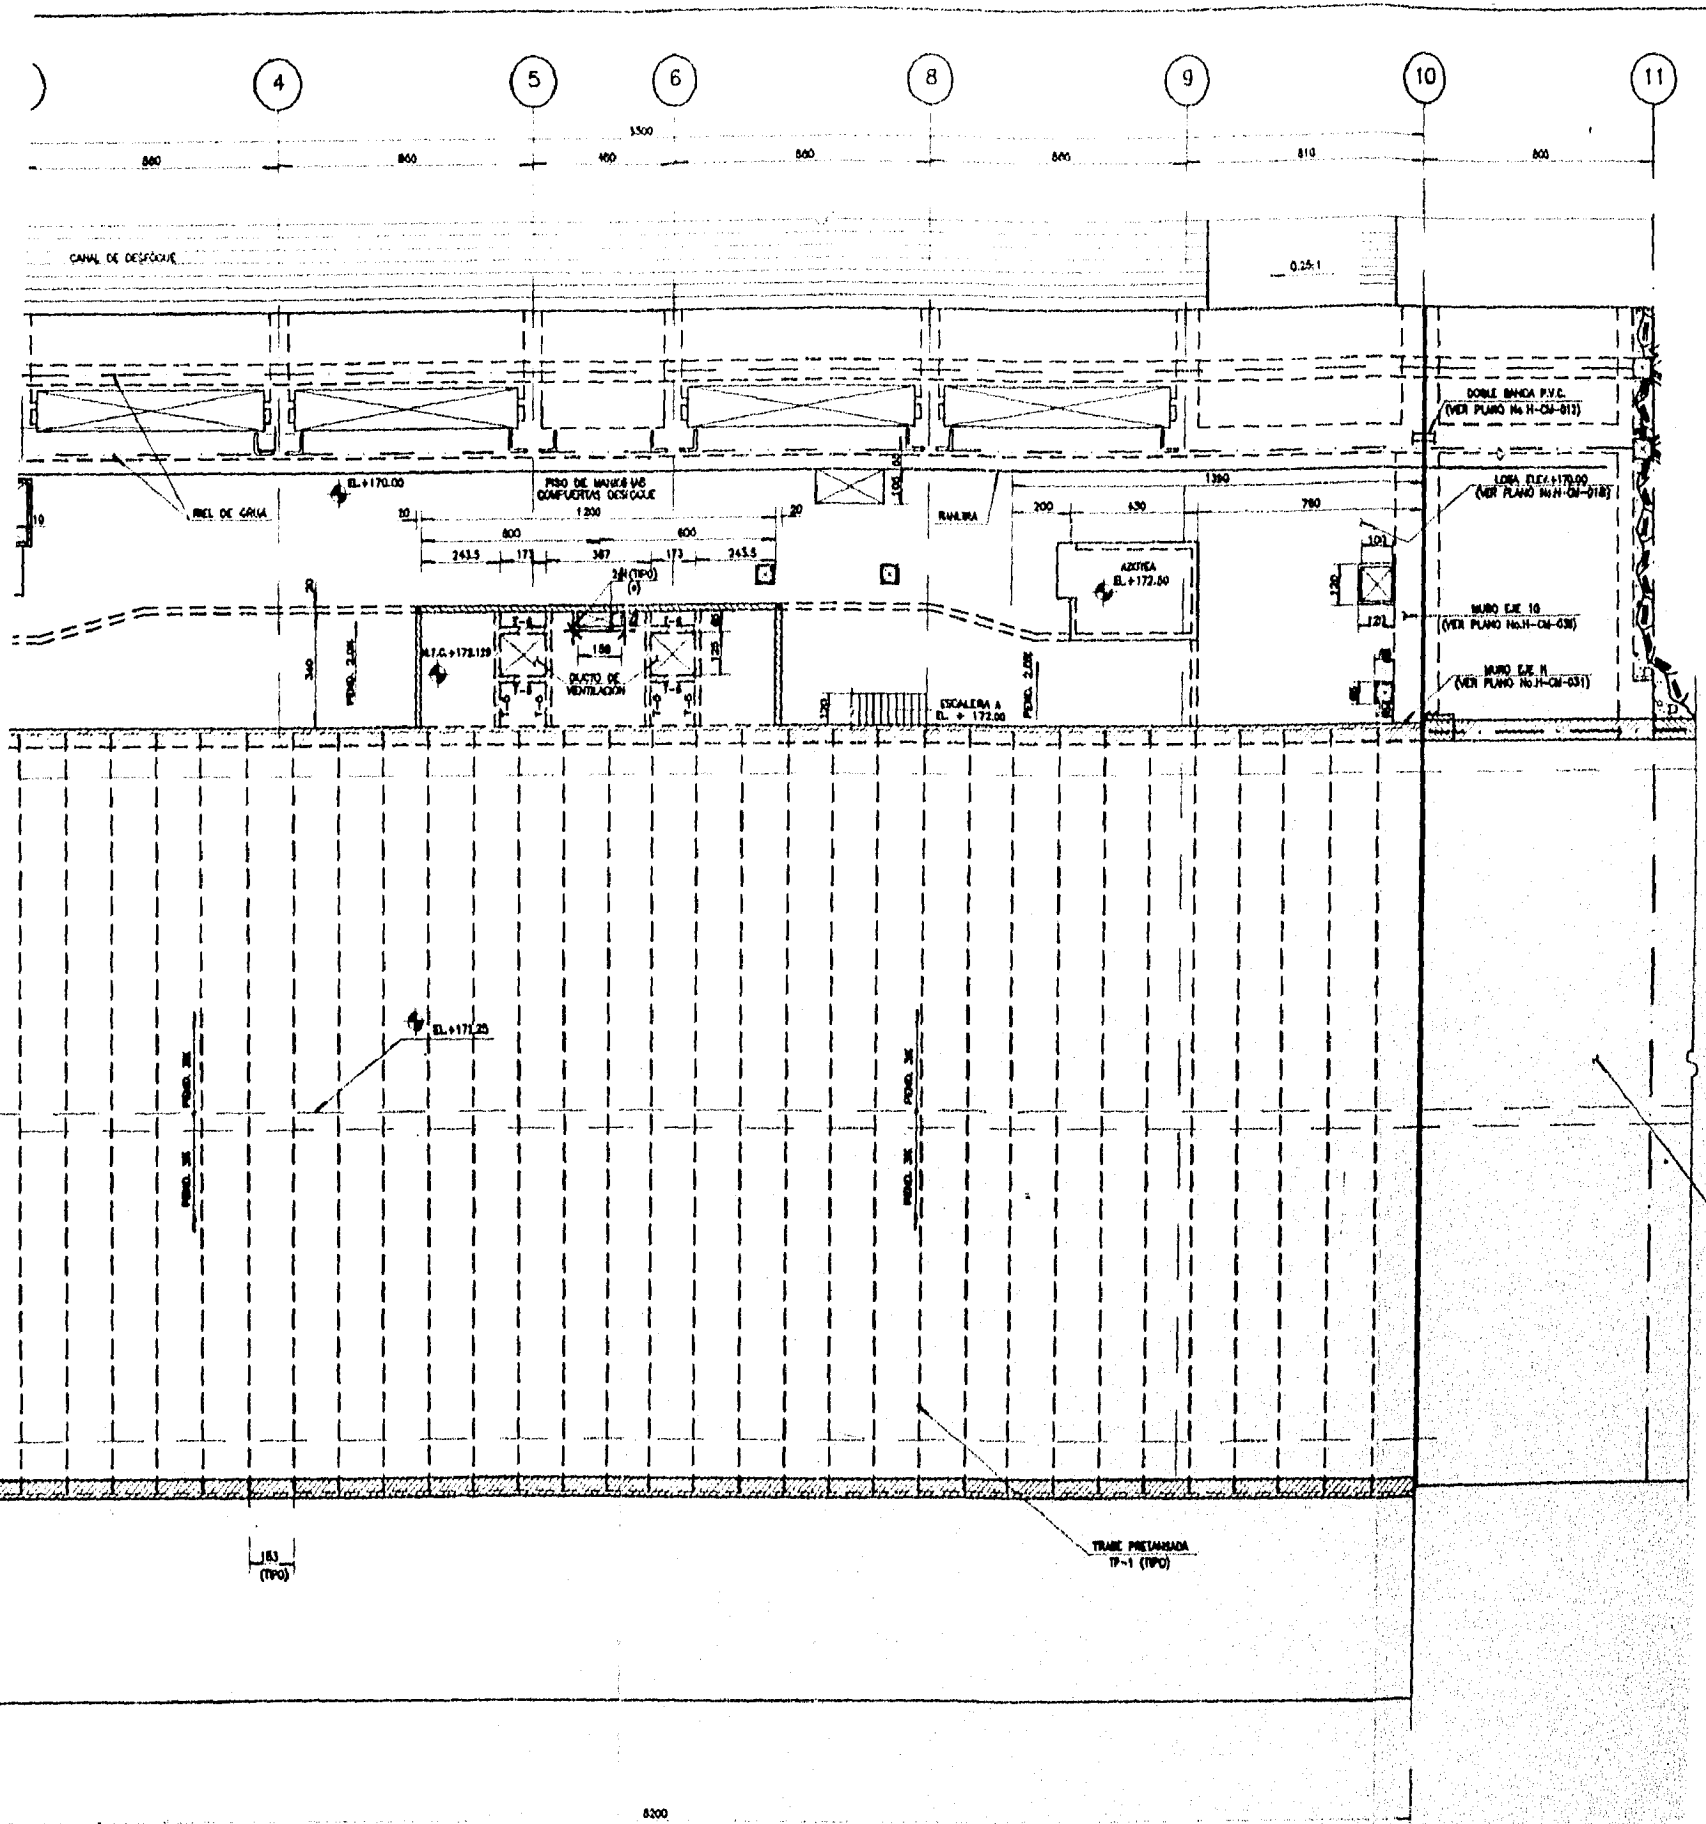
ESTRUCTURACION DE LA ALTERNATIVA DE CONCRETO PRESFORZADO (PRETENSADO)
